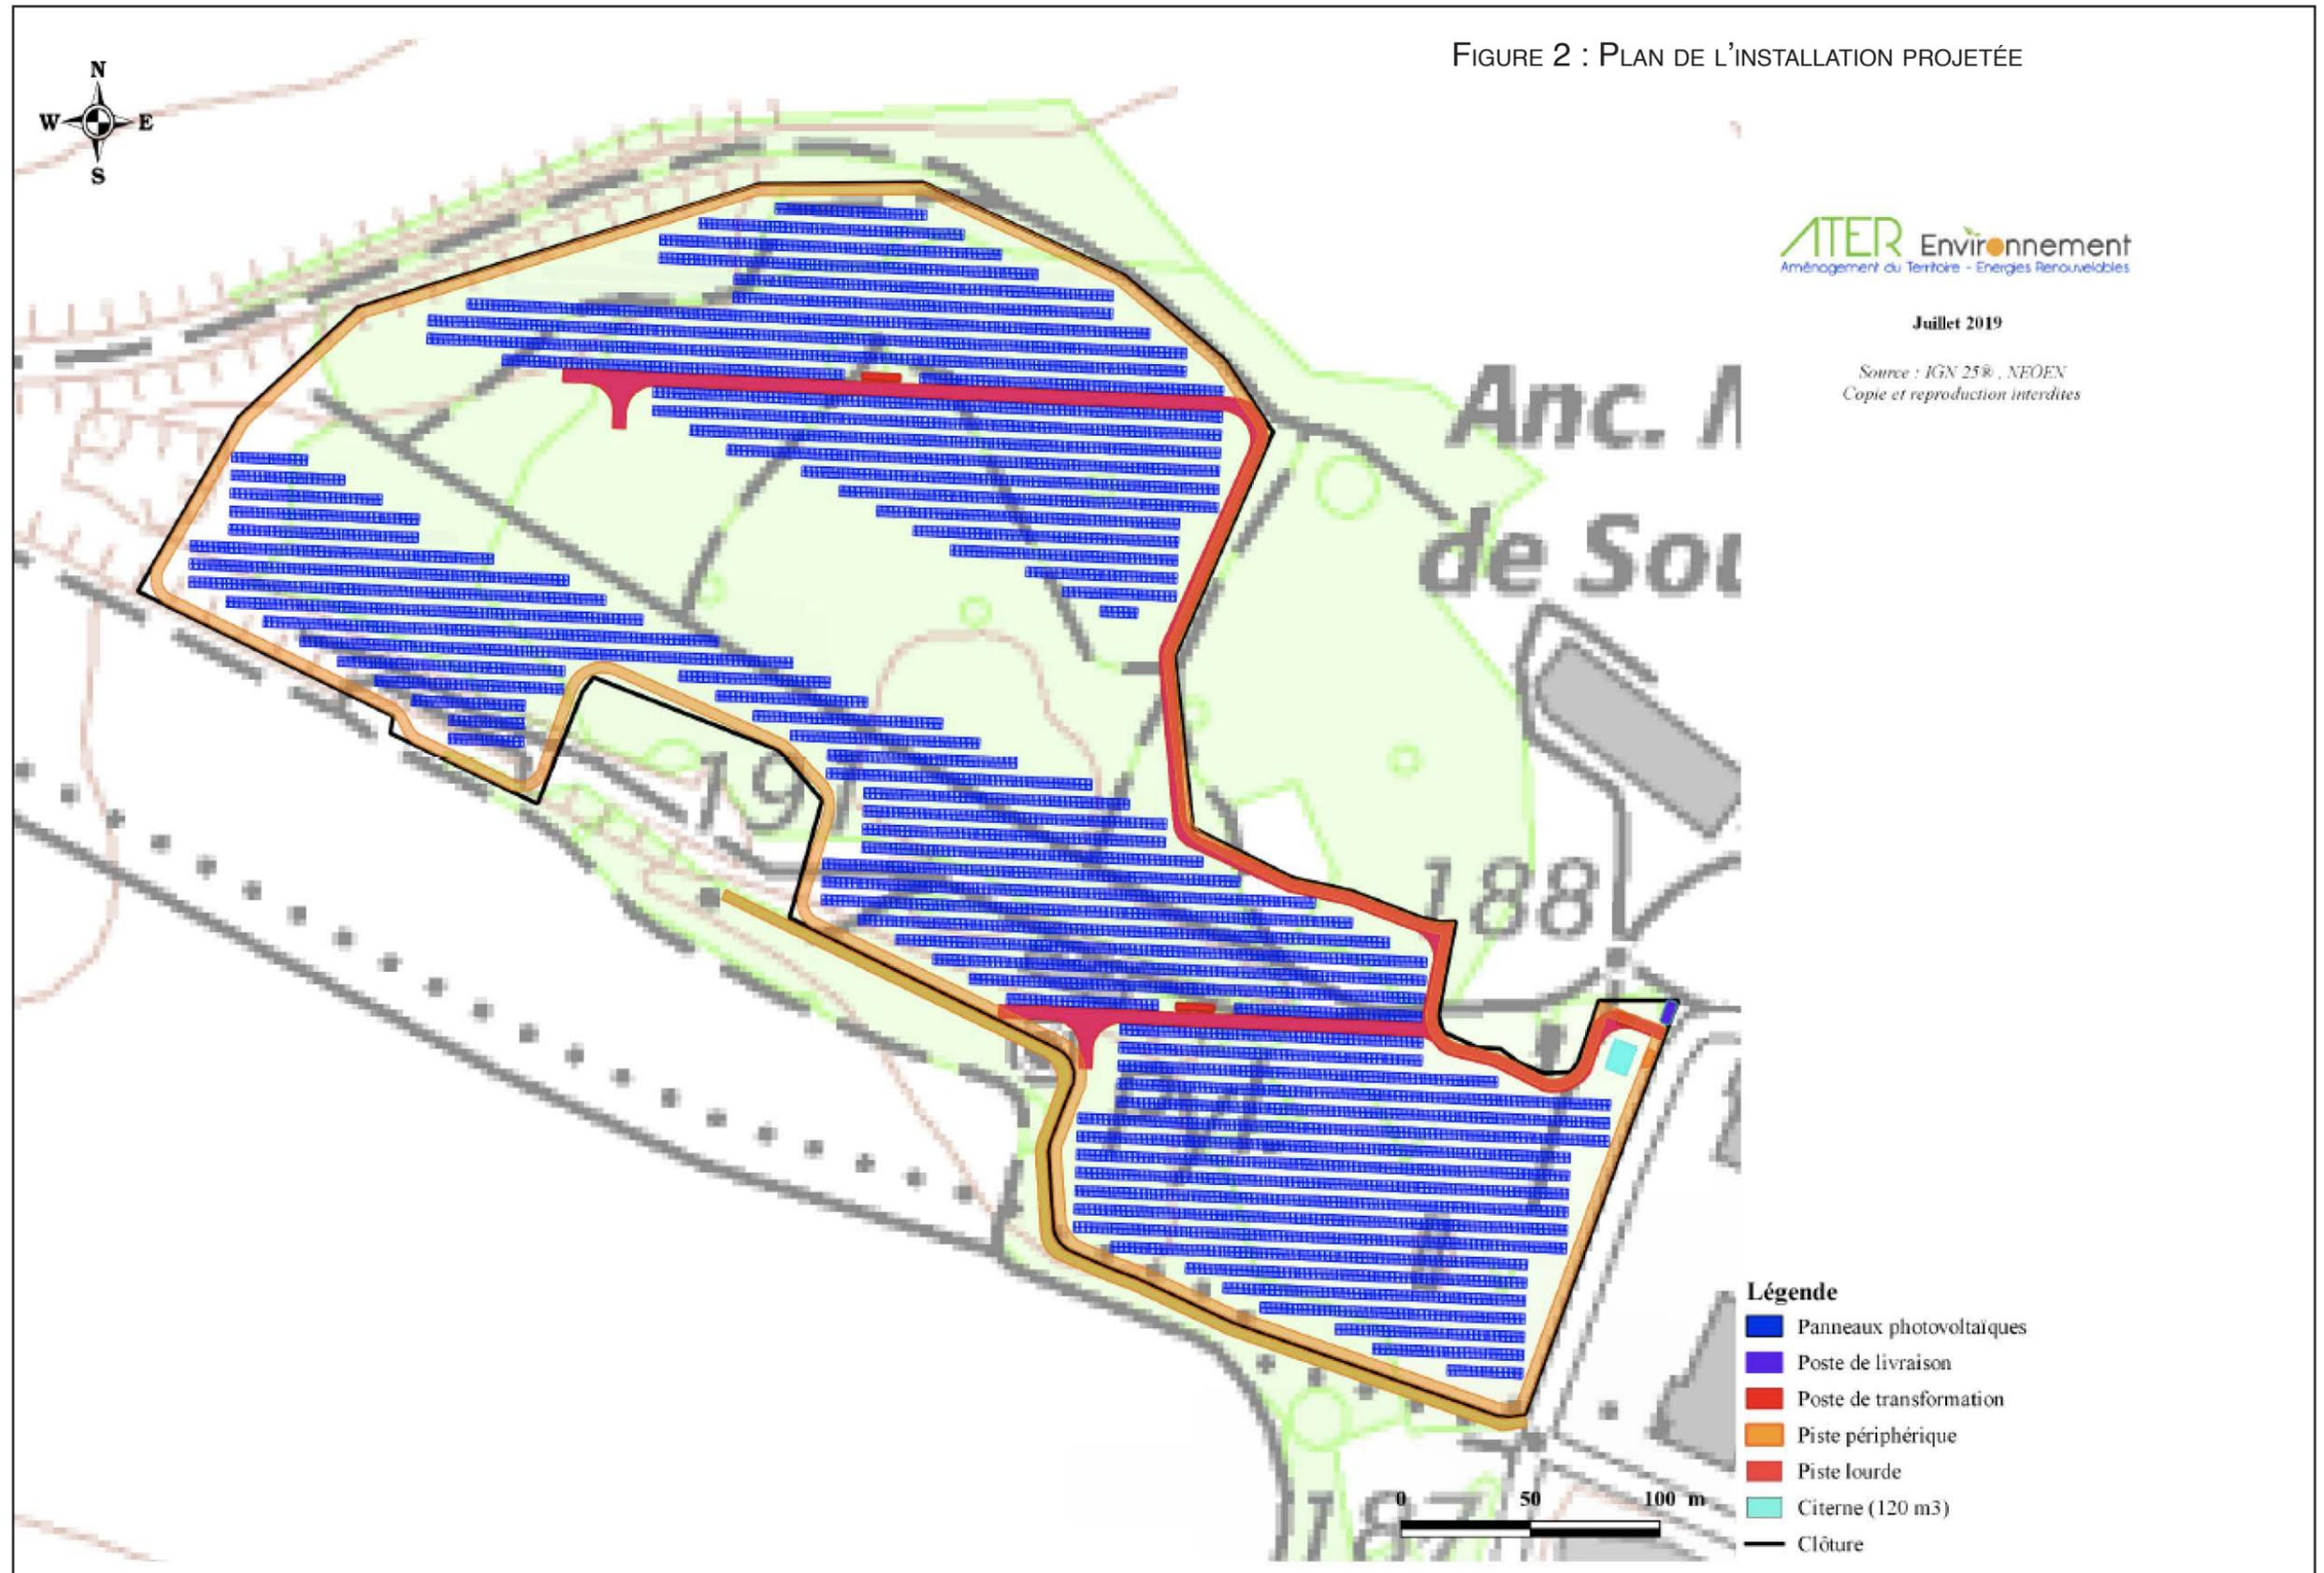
PLAN DE L'INSTALLATION PROJÉTÉE
